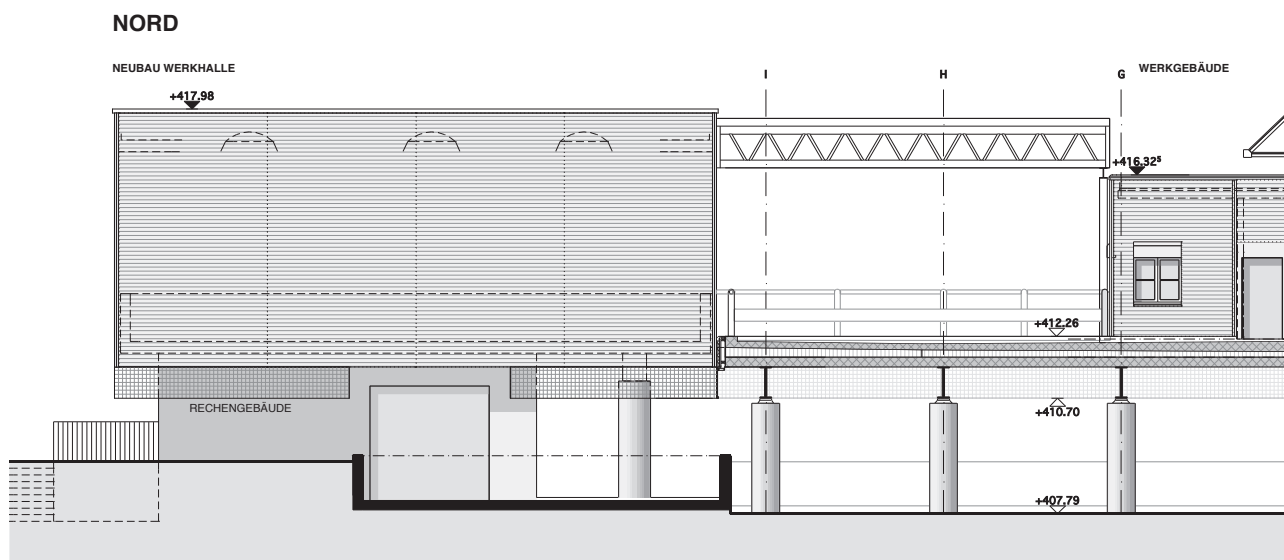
Nordfassade der Werkhalle mit Vordach und Teilen des bestehenden Werkgebäudes (rechts)
